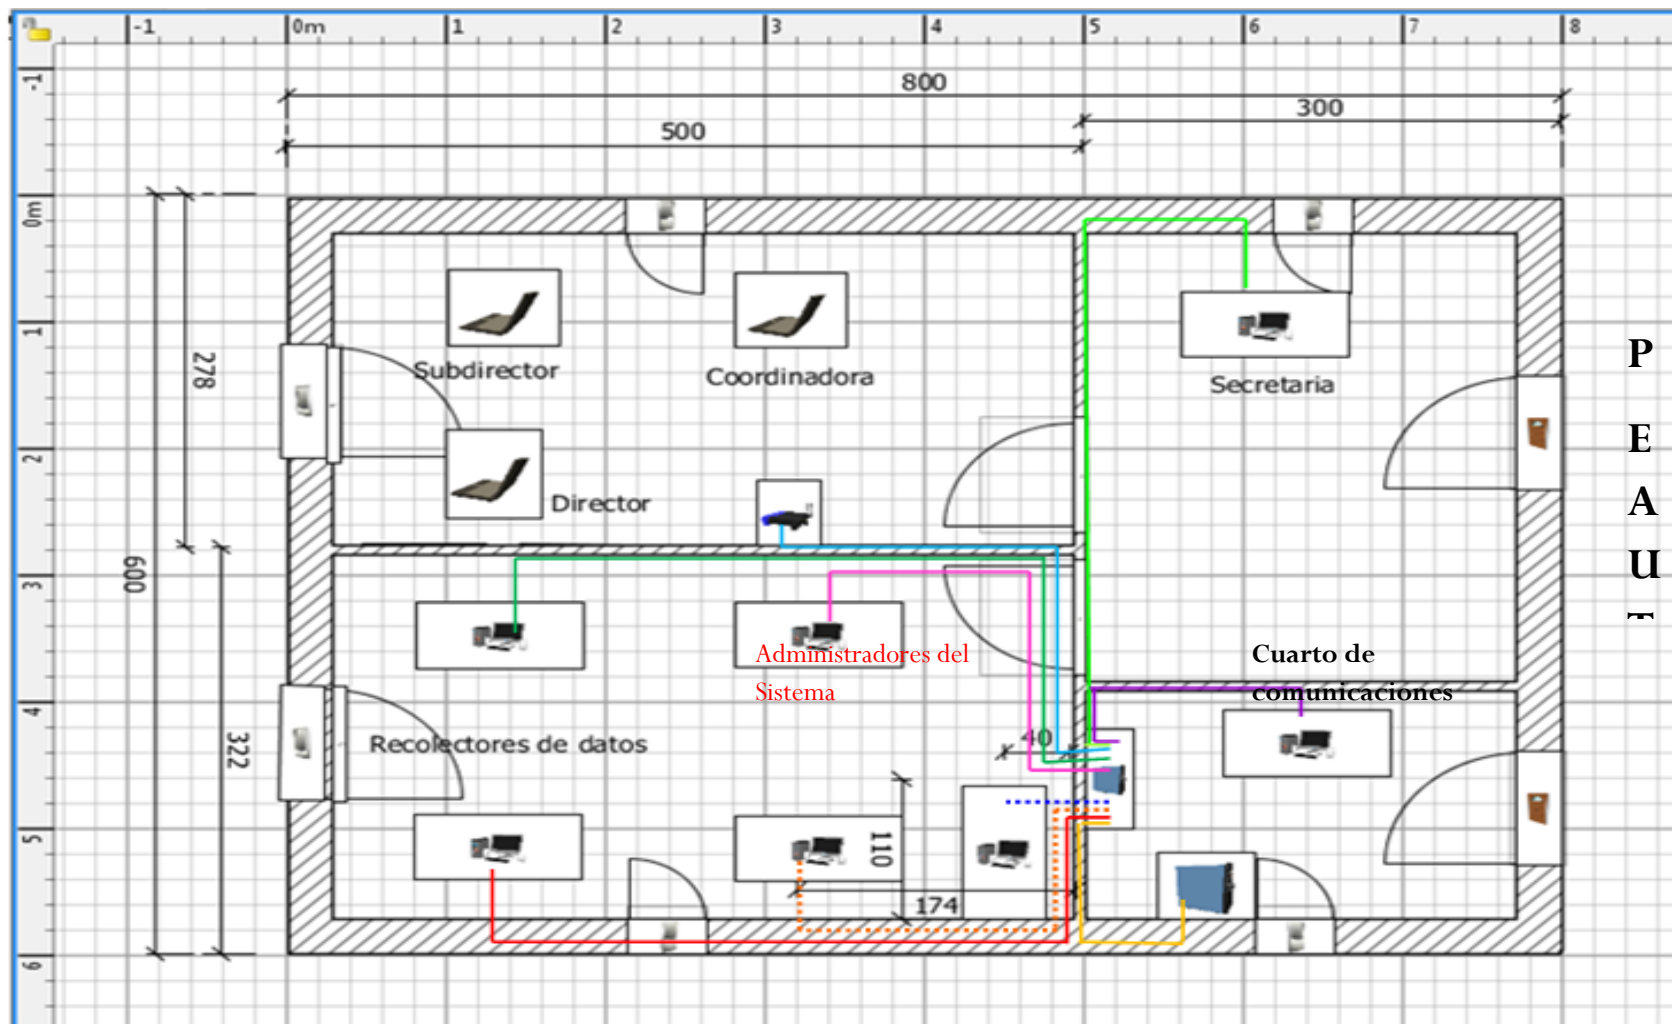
plano de red propuesta PEAUT
